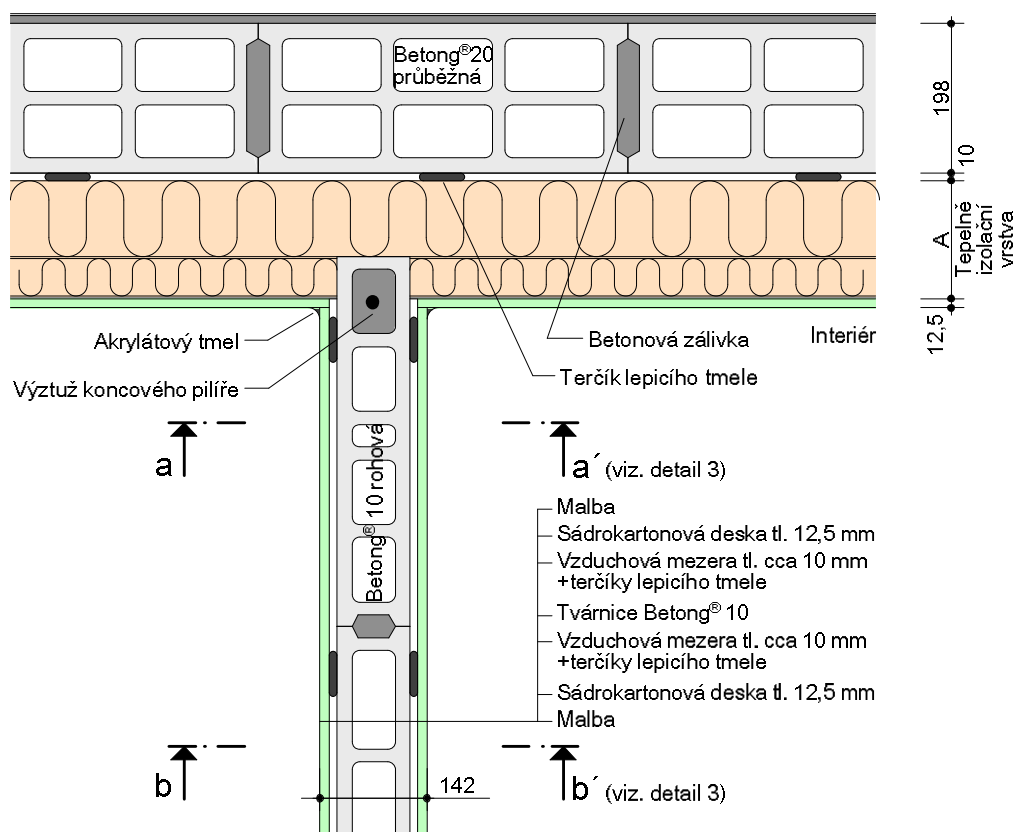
ROH OBVODOVÉ STĚNY-VNITŘNÍ ROH PŮDORYSNÝ ŘEZ
